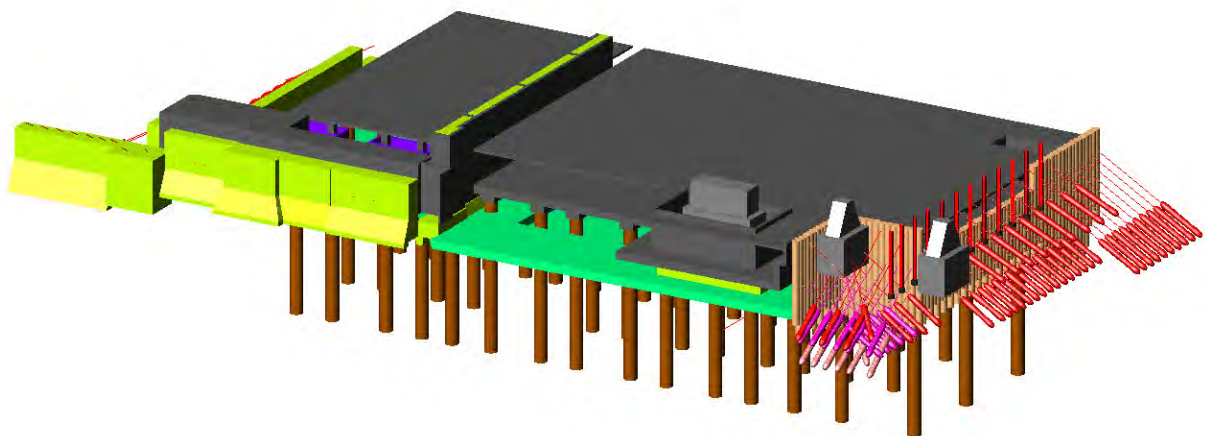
Bauwerkssohle mit Pfahlgründung und sonstigen Einbauten
